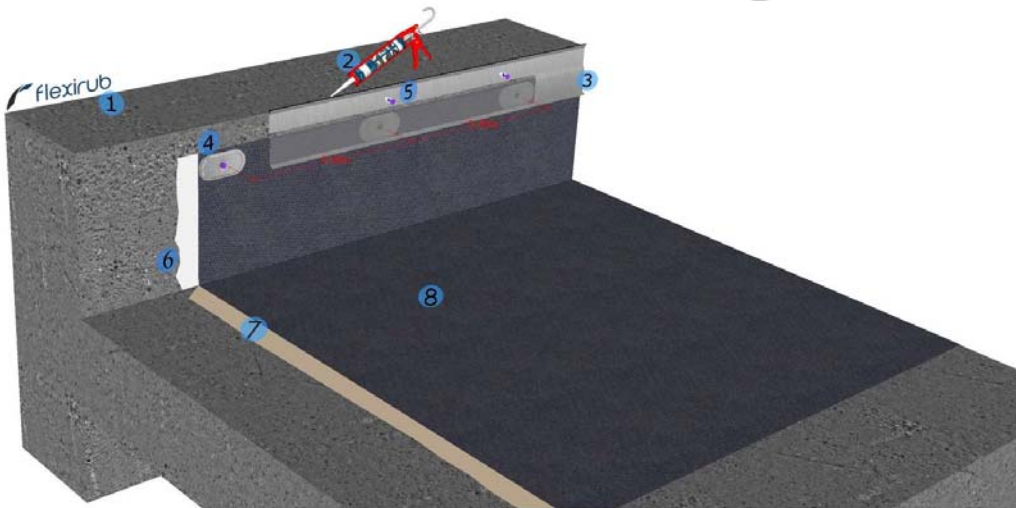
bis vue 3D– Exemple de finition de relevé par couverture
